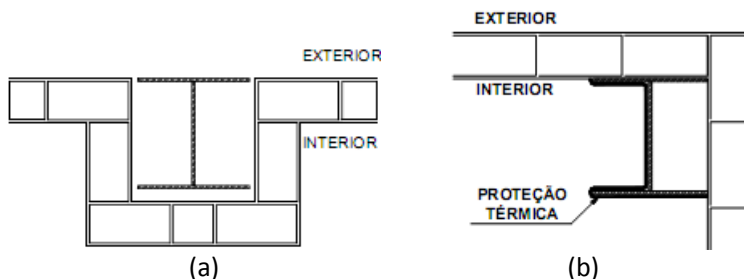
Pilar de fachada (linha) – interface com alvenaria (a), Pilar de Fachada (canto) – interface com alvenaria (b).
